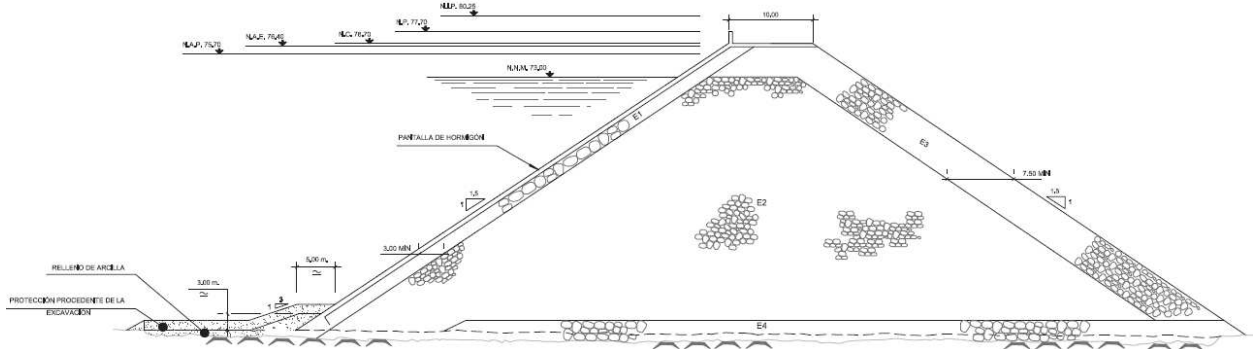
Sección tipo propuesta para la Alternativa 2: Recrecimiento de la presa
